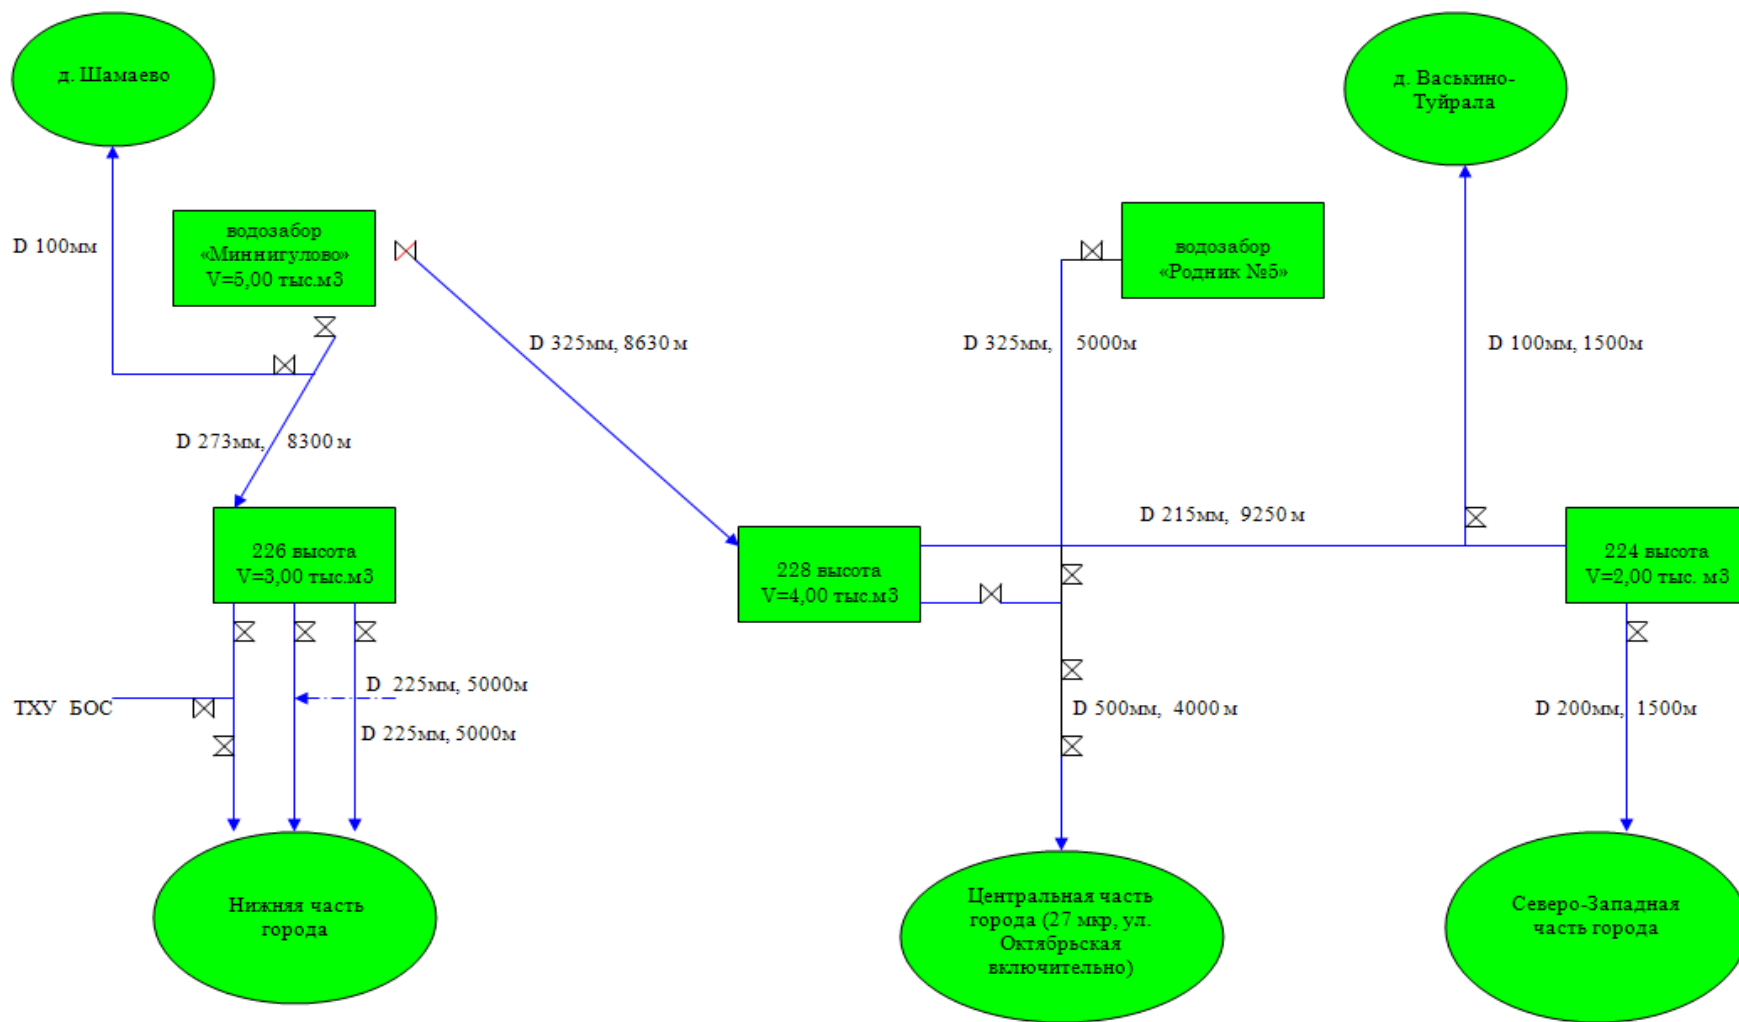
Схема подводящих водопроводных сетей г.Бавлы
